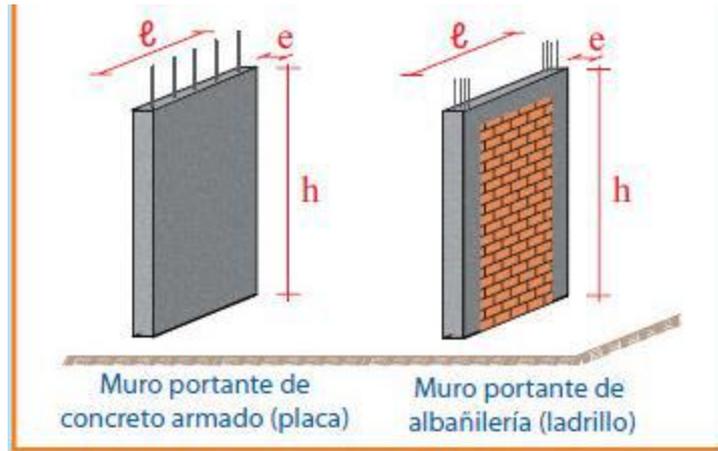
Muros de albañilería confinada. (Rojas R.)
